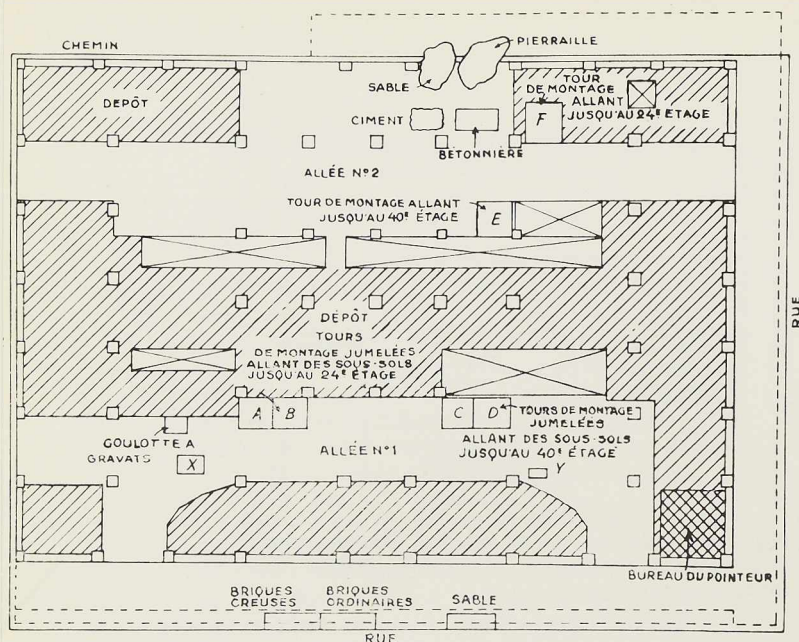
Bâtiment pour bureaux de 40 étages. Vue en plan du premier étage.
